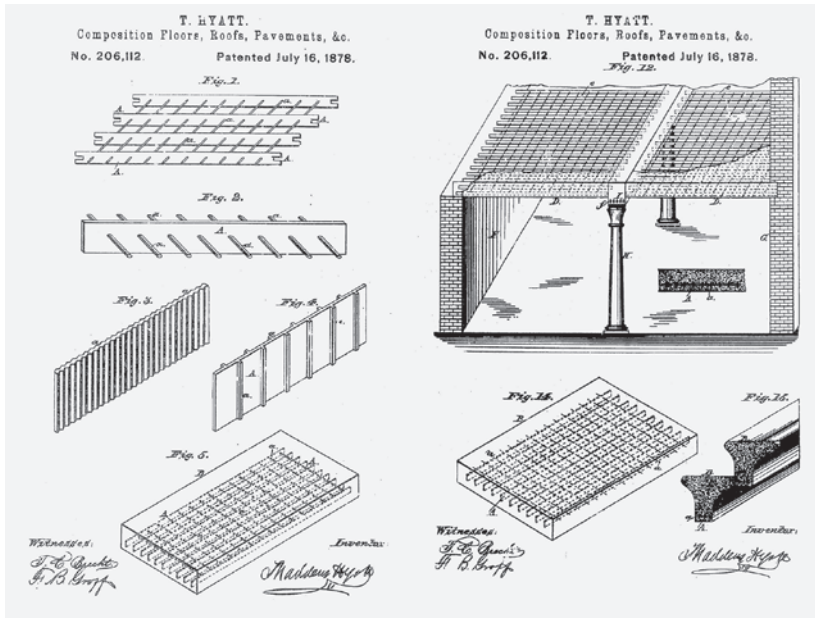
Brevetto N. 206112 di Thaddeus Hyatt (1878) per la realizzazione di solai, coperture e pavimenti.
